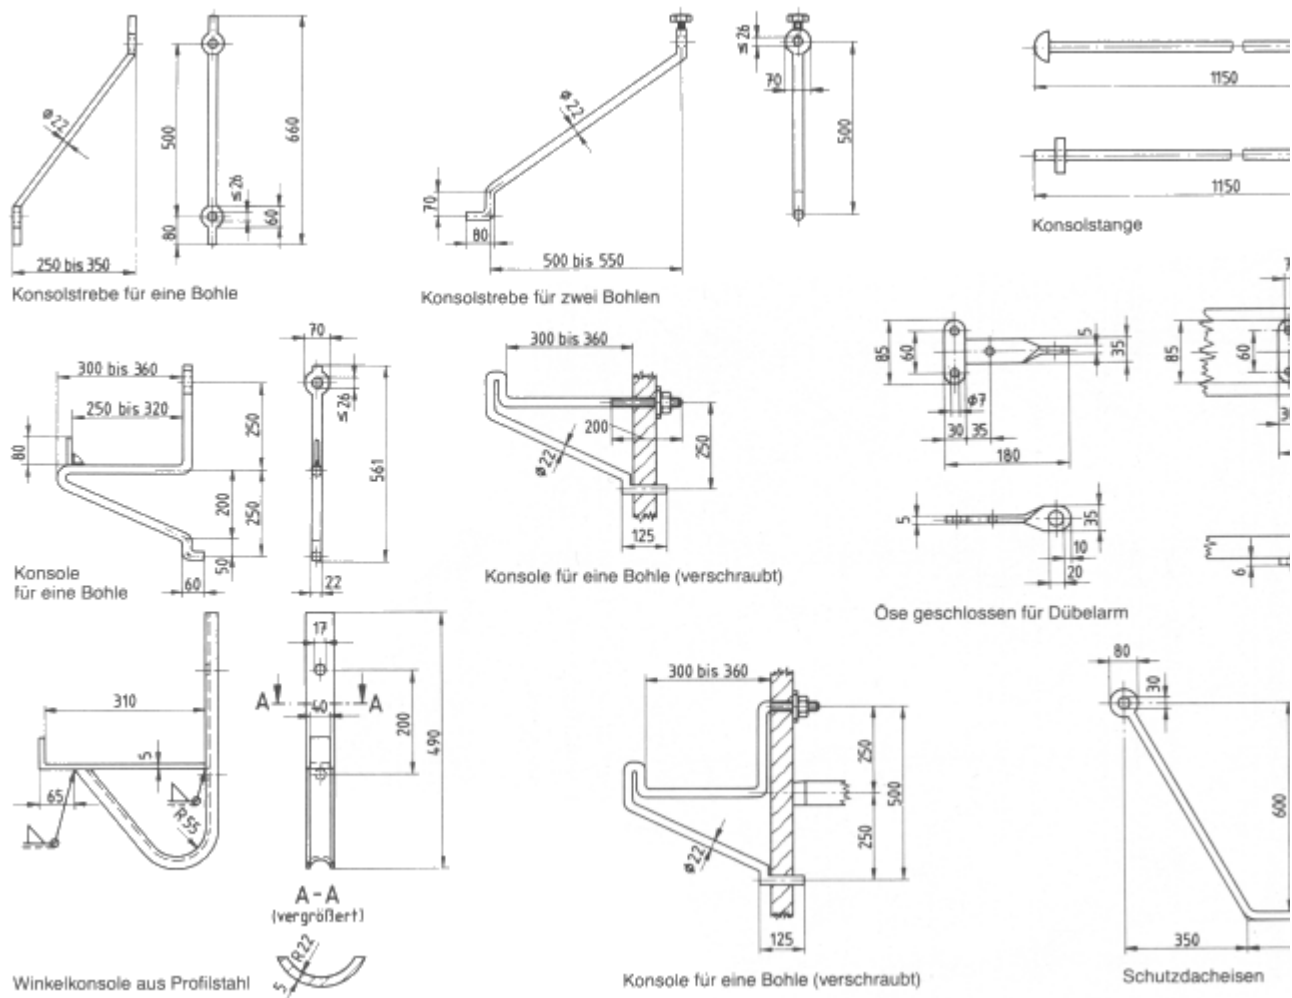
Formen, Maße und Ausführungen von Leitergerüstbauteilen aus Stahl (Maße in mm)
